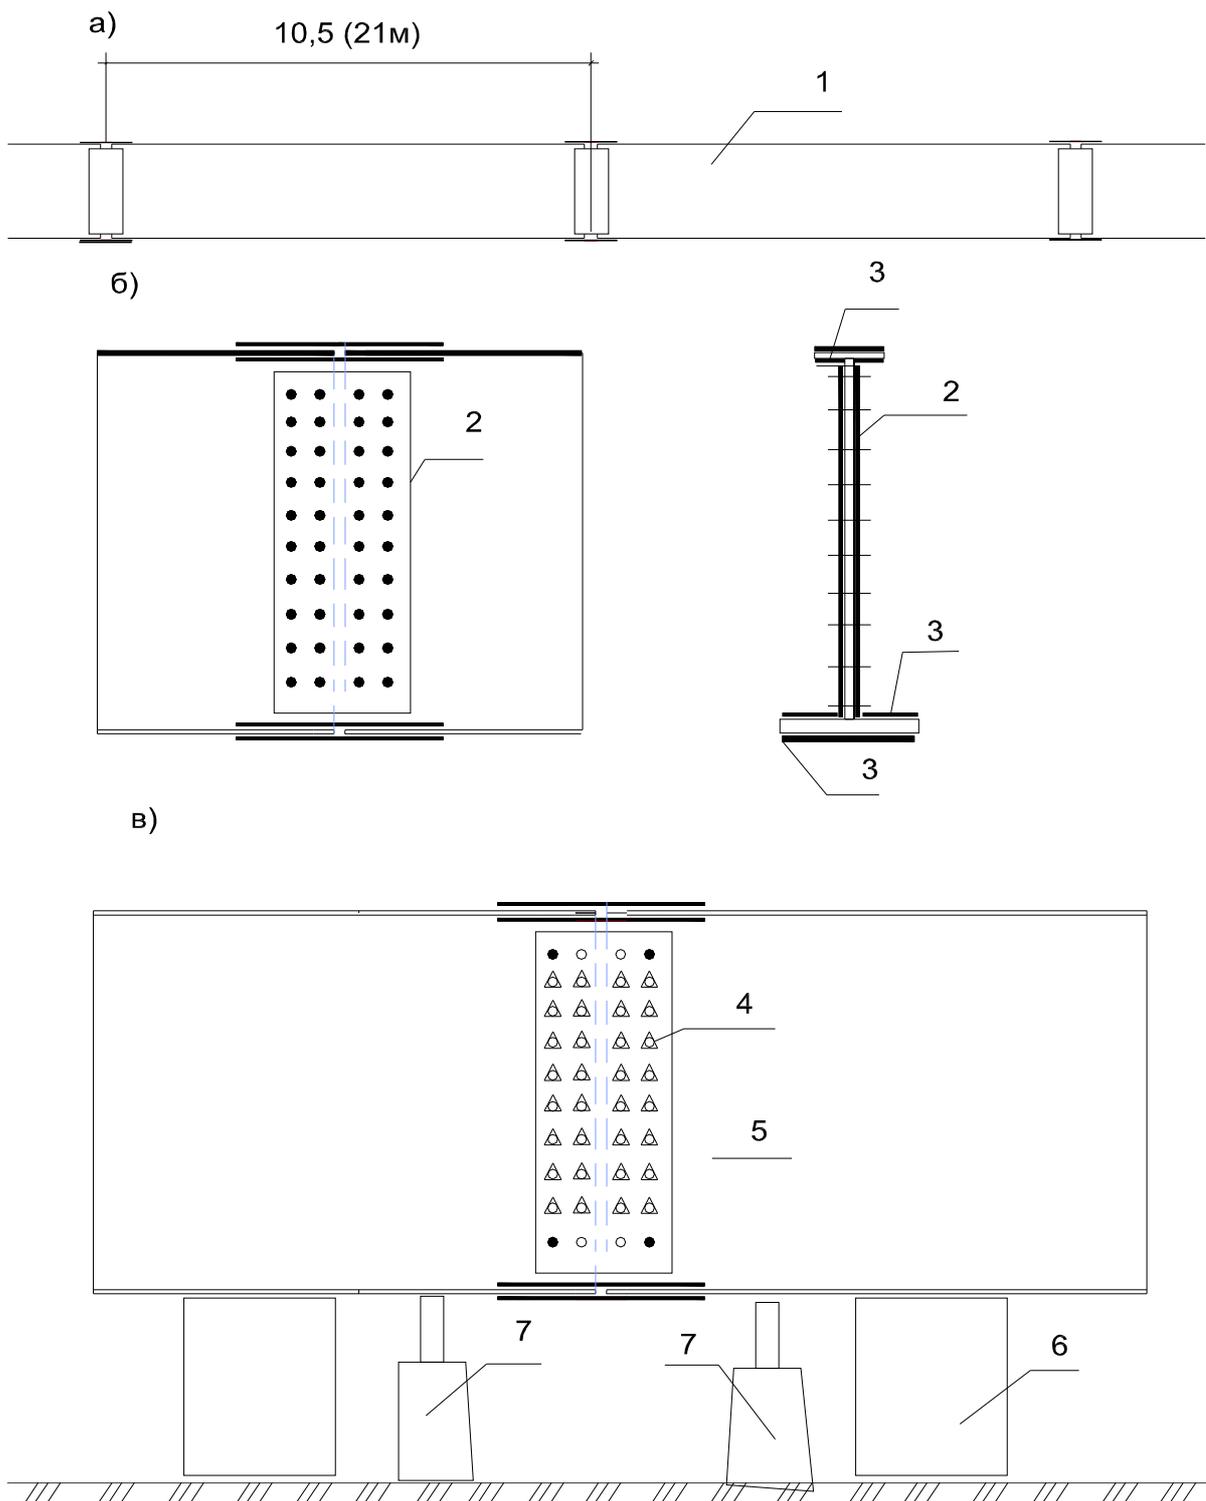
Монтажные стыки главных балок типовых сталежелезобетонных пролетных строений: а-расположение монтажных стыков по длине; б-конструкция стыка; в-схема сборки стыка на сборочной площадке или на подмостях; 1-блоки главных балок; 2-накладки стенки; 3-накладки поясов; 4-высокопрочные болты; 5-монтажные пробки; 6-сборочные клетки; 7-домкраты для выравнивания блоков по высоте
